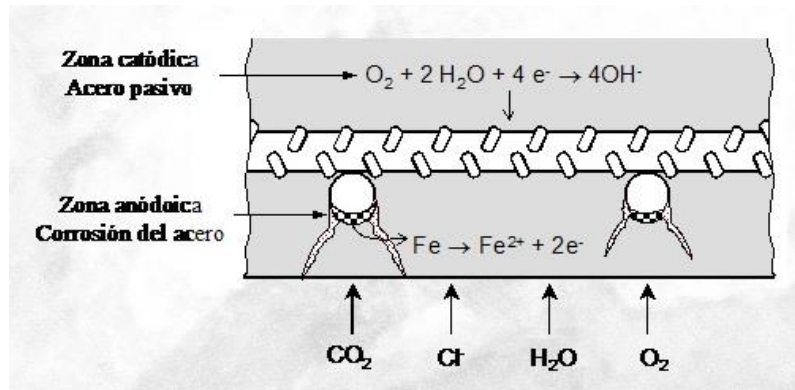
Representación esquemática del proceso electroquímico de corrosión de las armaduras en el hormigón. Husni, R. Acciones sobre las estructuras de hormigón [Figura]. Recuperado de http://www.mda.cinvestav.mx/alconpat/internacional/contenido/re_ebook_ai/DEMO_R/HTML/Capitulo1/Capitulo.htm
